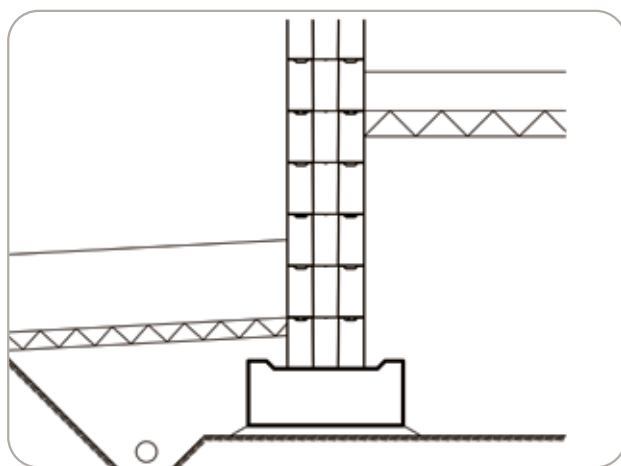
Murad kryprumsgrund, ritning L 1-301.
